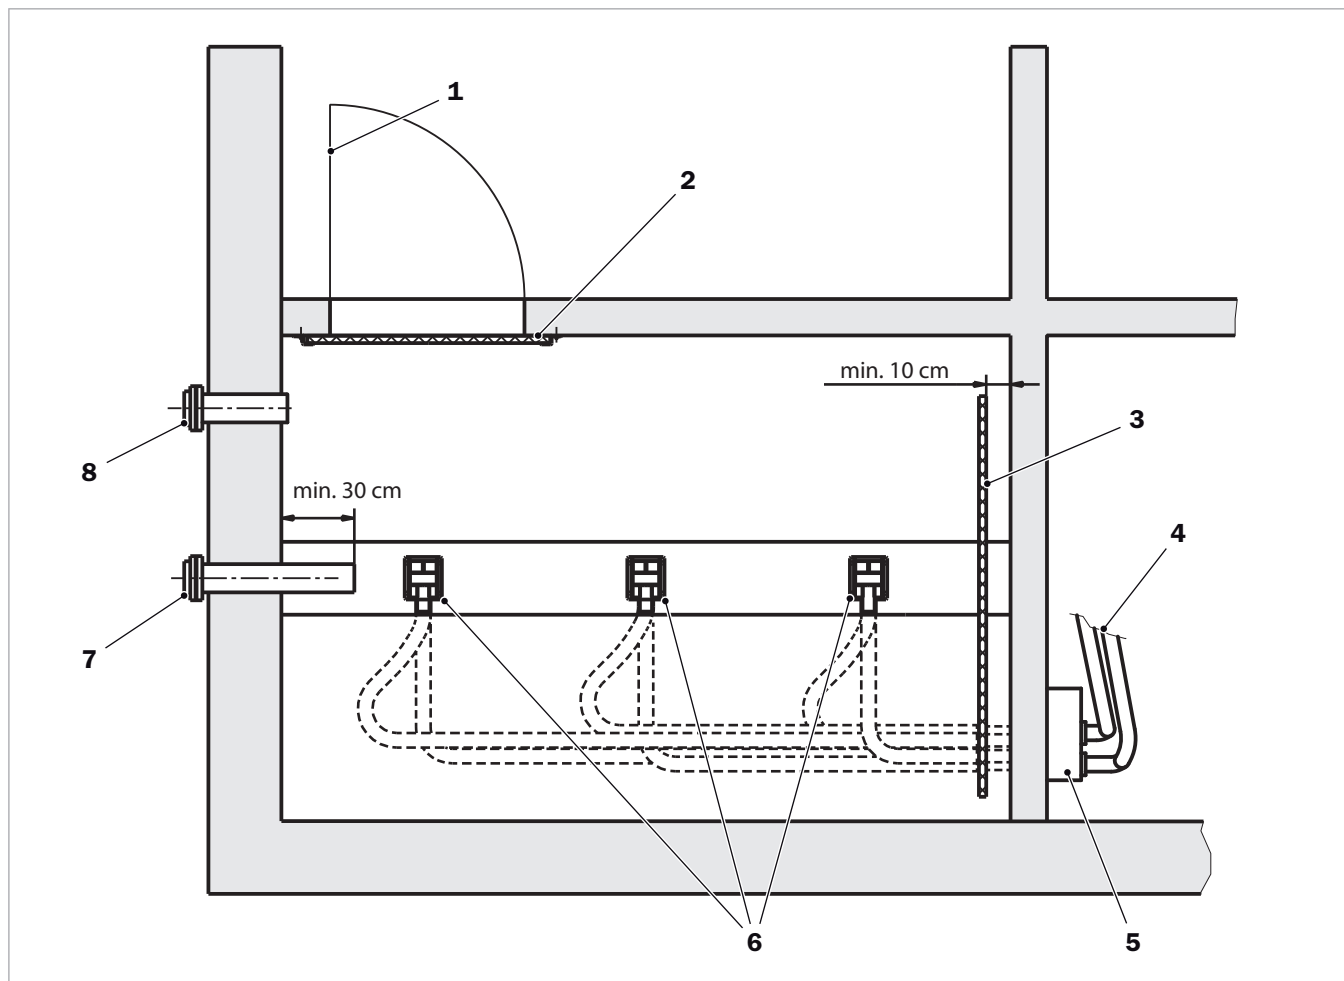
Pellet-Lagerraum – Ansicht von oben
